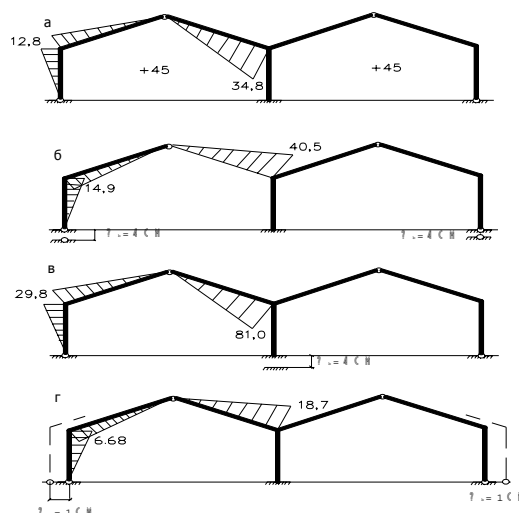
Эпюры моментов от воздействия: а – температуры; б – осадки крайних опор; в – осадки средней опоры; г – горизонтального смещения крайних опор
